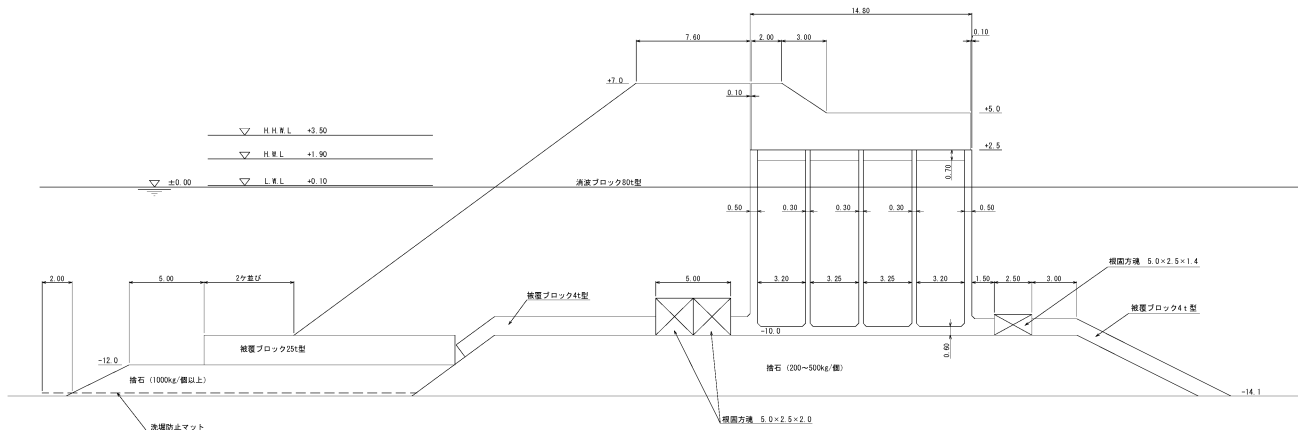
標準断面図 (防波堤 I, 単位 : m)
